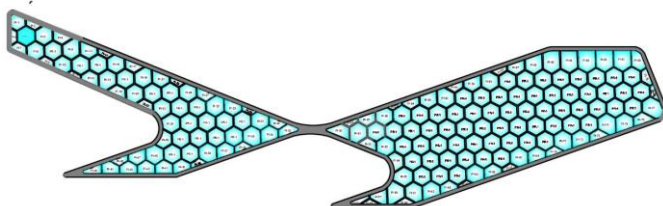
Detalle estructural de las burbujas 2. Fuente: elaboración propia. Año: 2017.
